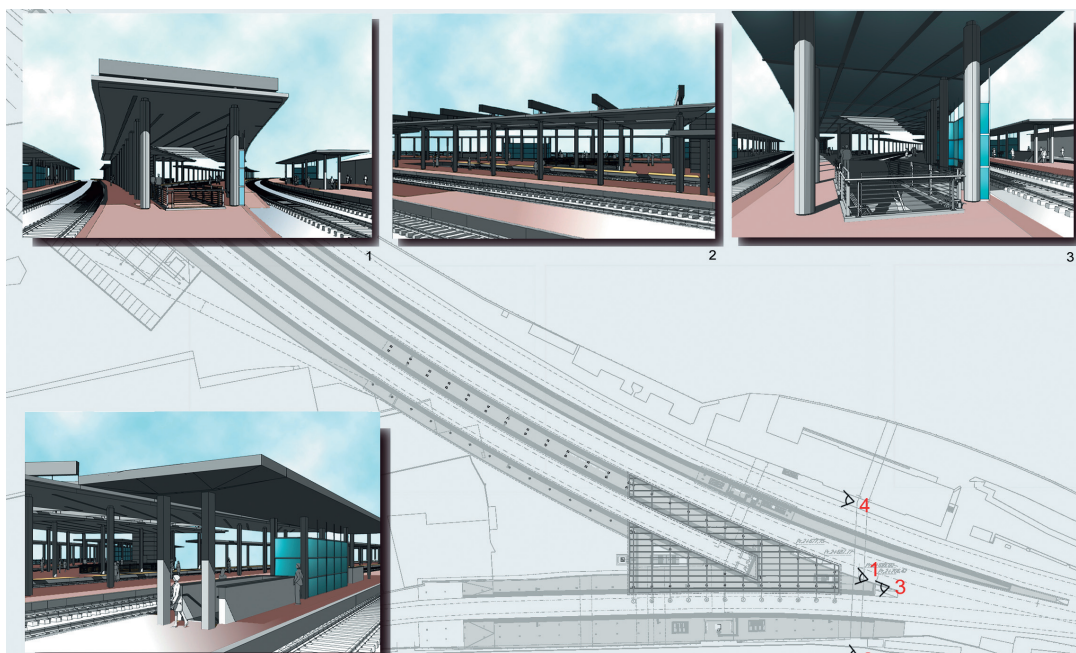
Intervento presso la stazione di Genova Sampierdarena: rendering delle viste prospettiche dei marciapiedi.
